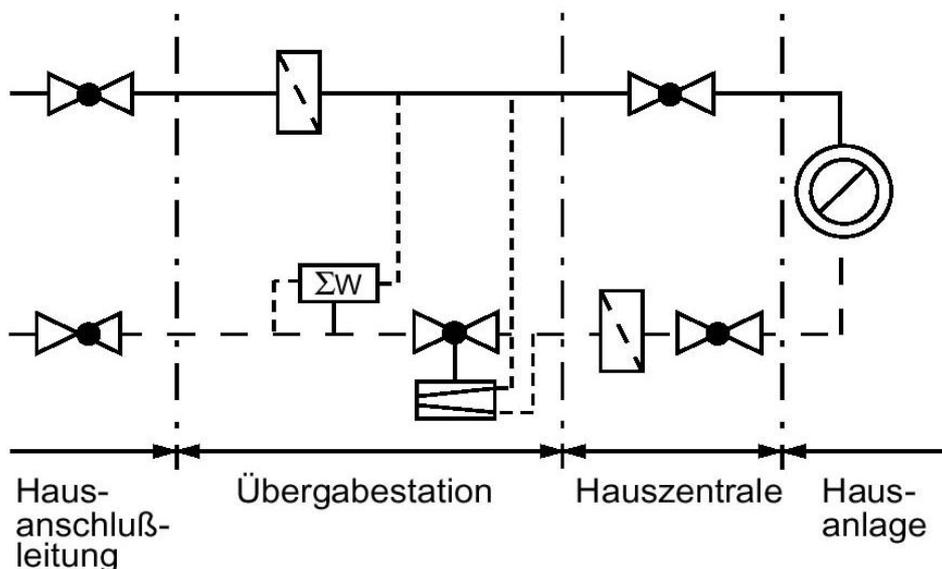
Beispiel einer Hausstation [2]
